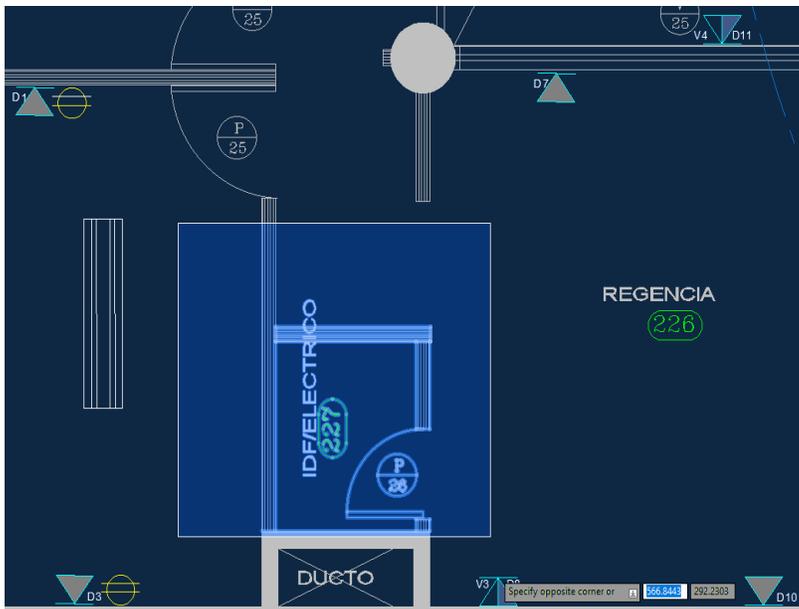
Ubicación del centro de cableado de piso TR, planta alta. Planos de infraestructura de Sinter S.A
